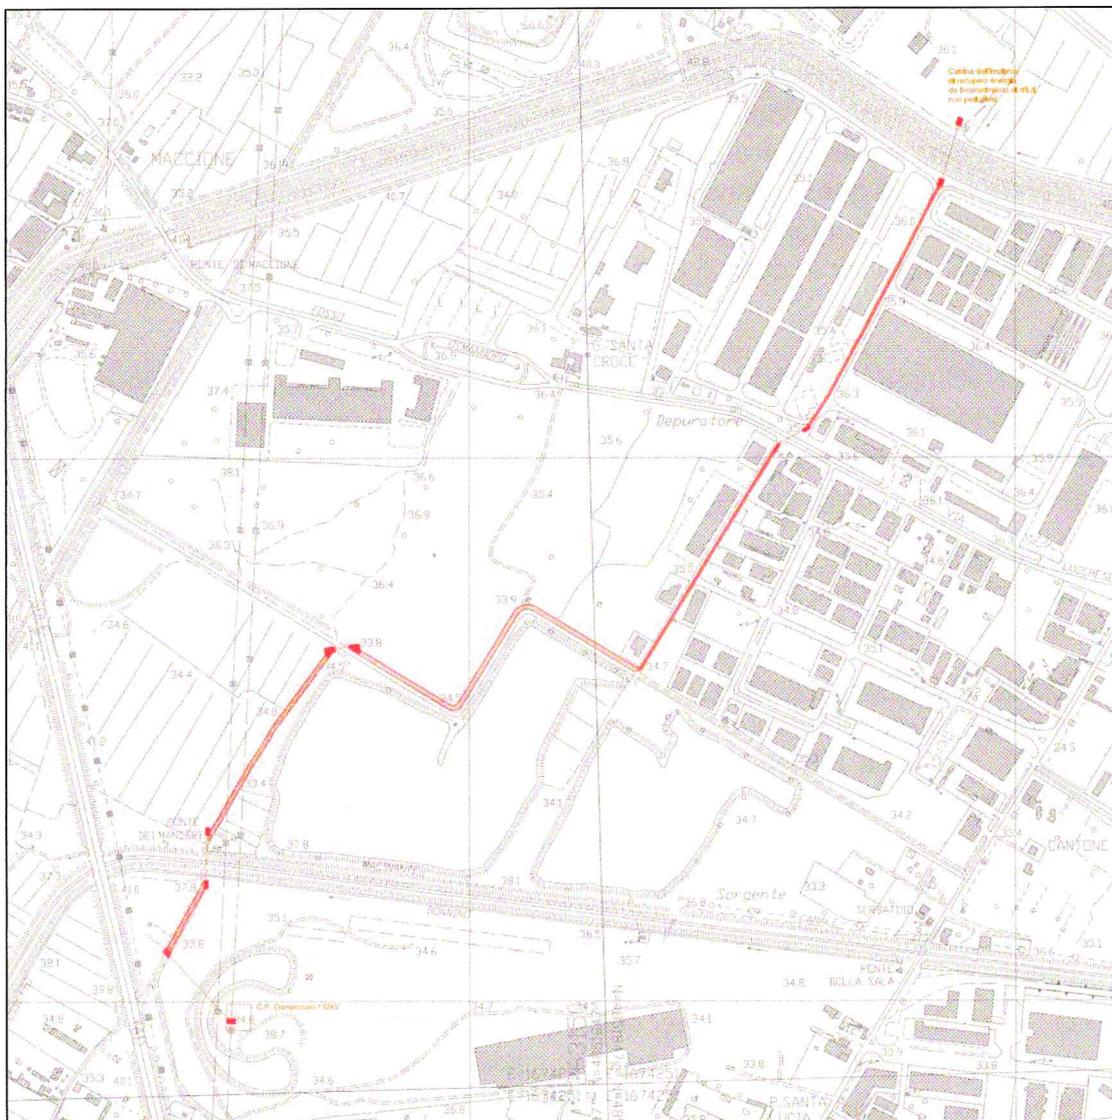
Tracciato di progetto della linea elettrica interrata di connessione alla rete di distribuzione ENEL
